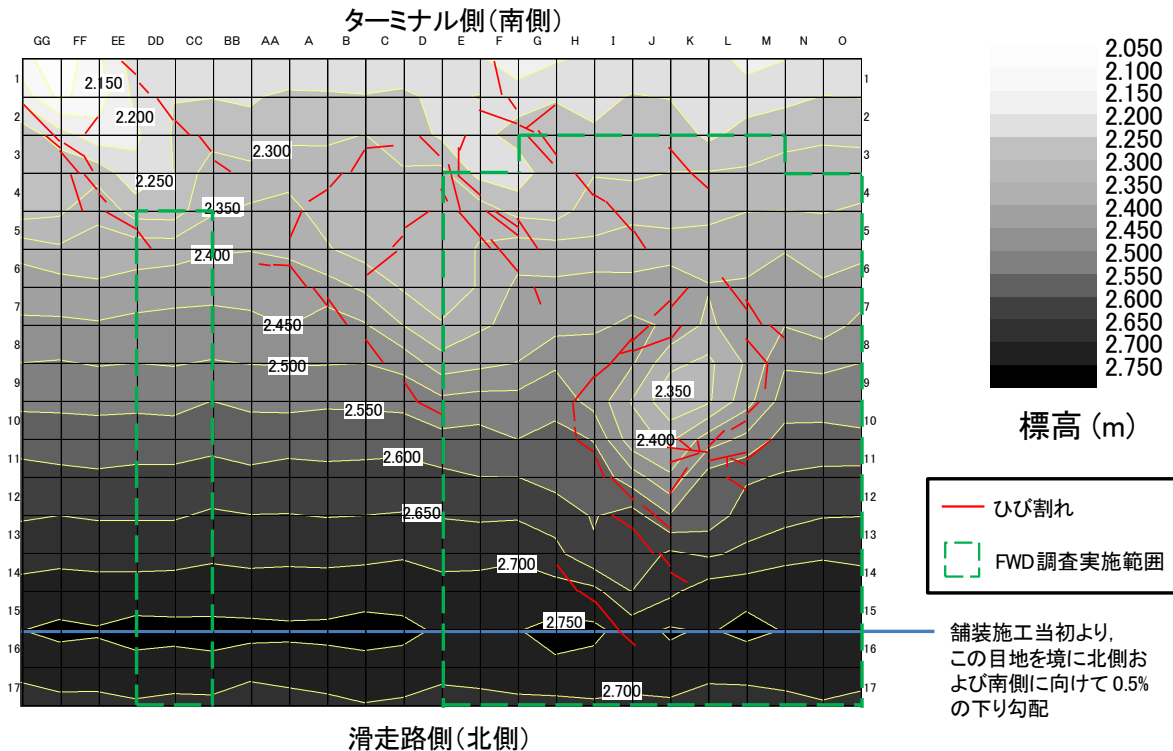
エプロンの高さおよびひび割れ発生位置 (升目は一枚のコンクリート版を示す)
